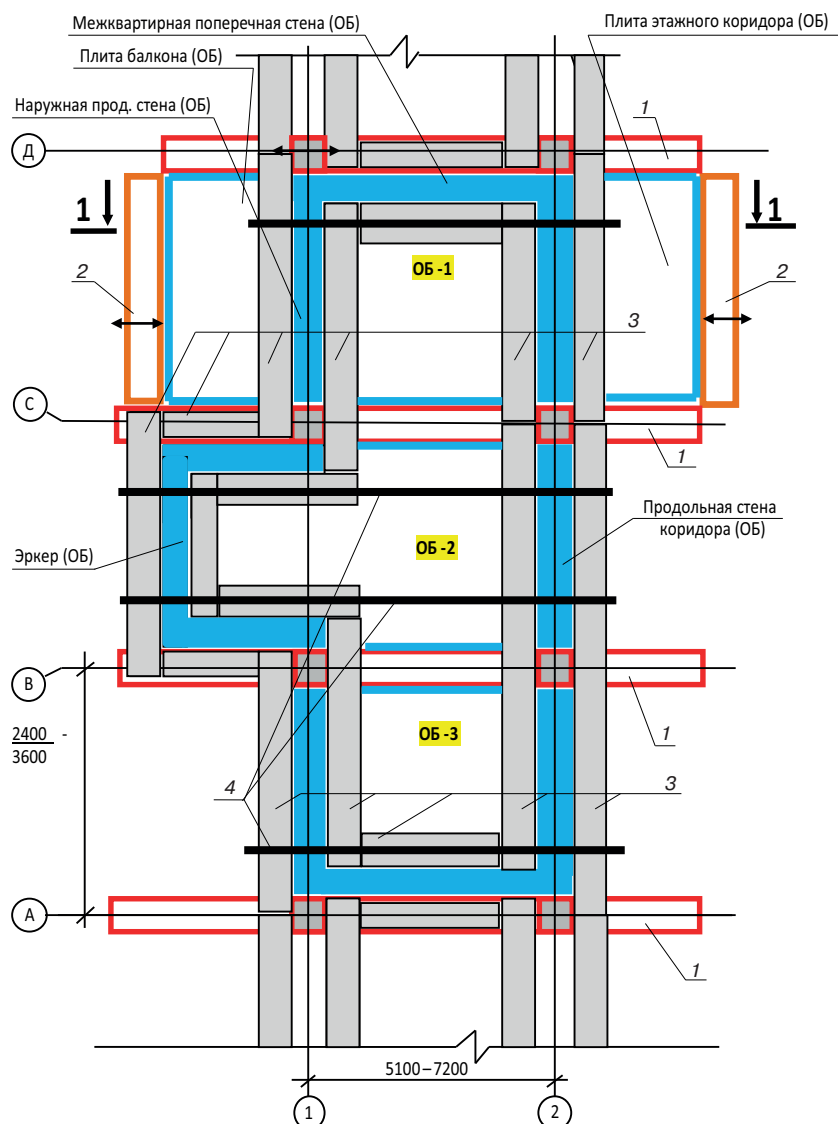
Заливка стен квартиры на стапеле (модуль однокомнатной квартиры состоит из трех объемных блоков ОБ-1, ОБ-2, ОБ-3): 1 – поперечная рама стапеля; 2 – продольные борты плит этажного диска перекрытия; 3 – щитовая опалубка стен объемного блока; 4 – верхние балки для крепления внесистемных щитов опалубки стен объемного блока
